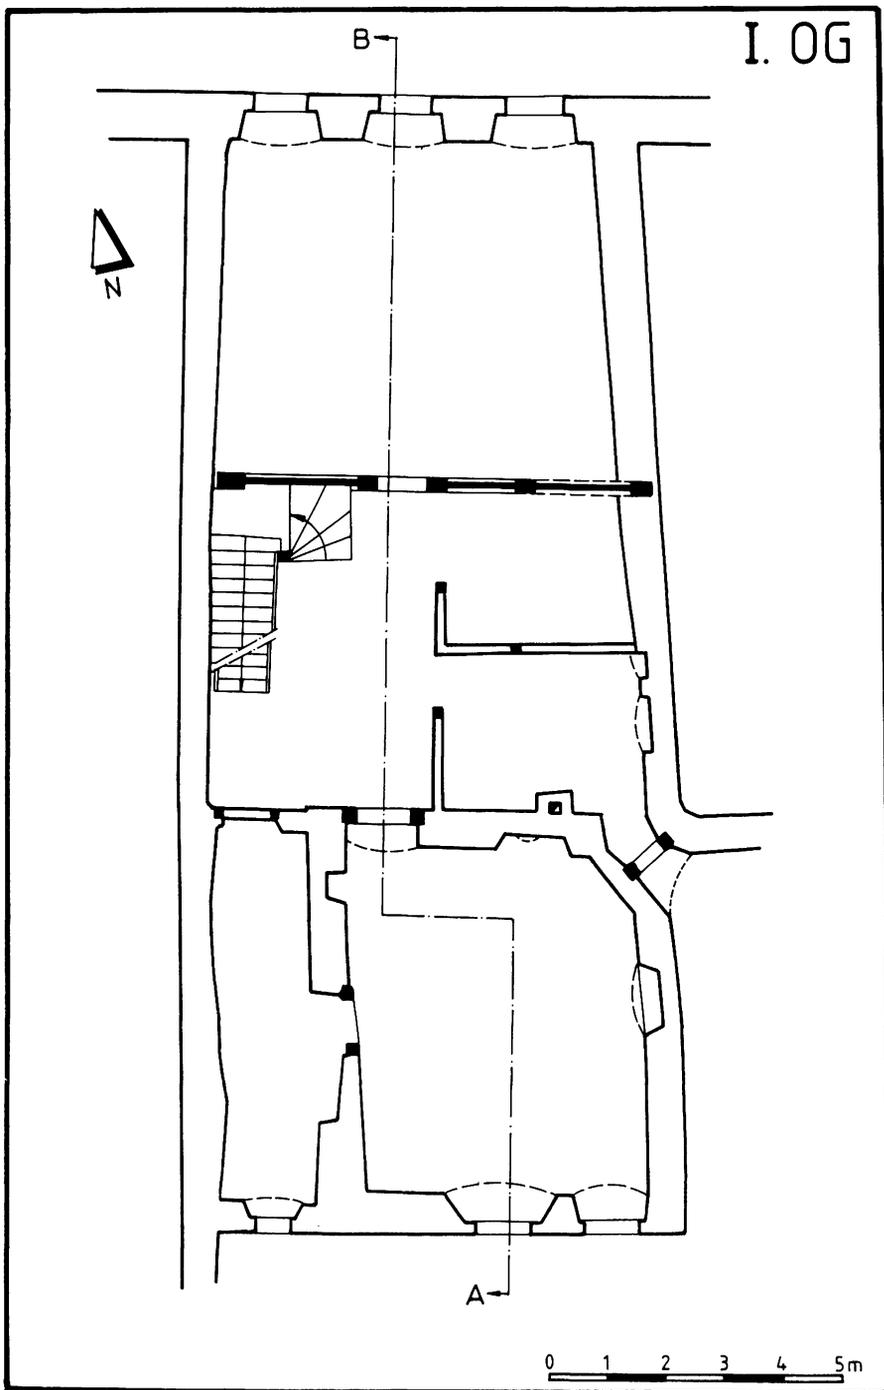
Grundriß 1. Obergeschoß (nach Kirchner, schematisiert)
